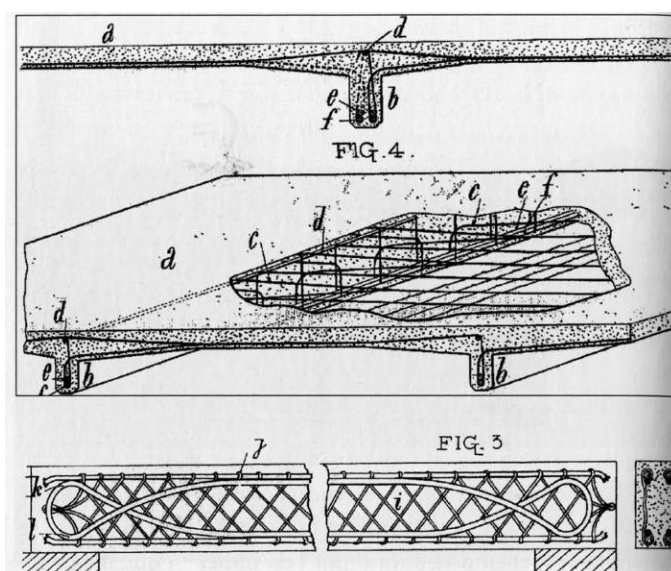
Sistema Blanc "viga-forjado", Patente española 1901.
